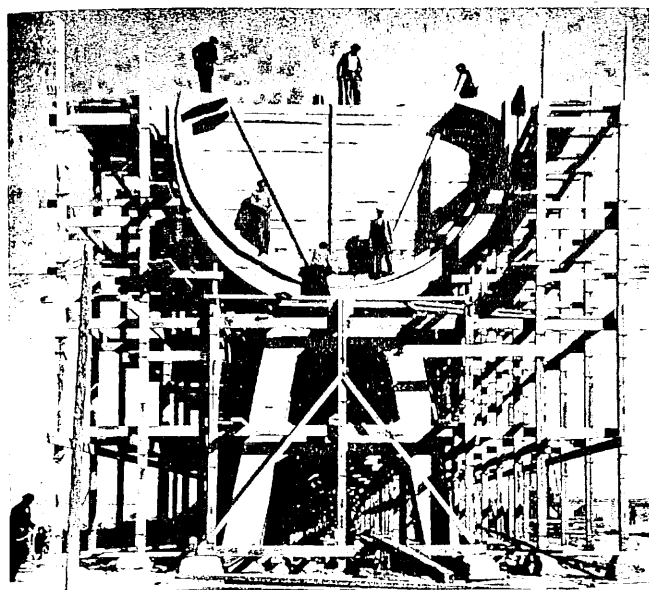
ª — Sección terminal del tramo construido, cerrada para la prueba.
